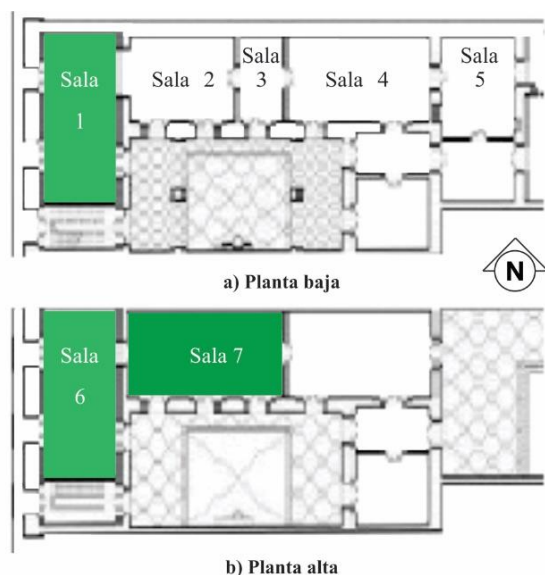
Planimetría del MHNA a) Planta baja: ubicación de sala 1 a sala 5 y b) Planta alta: ubicación de sala 6 y sala 7
